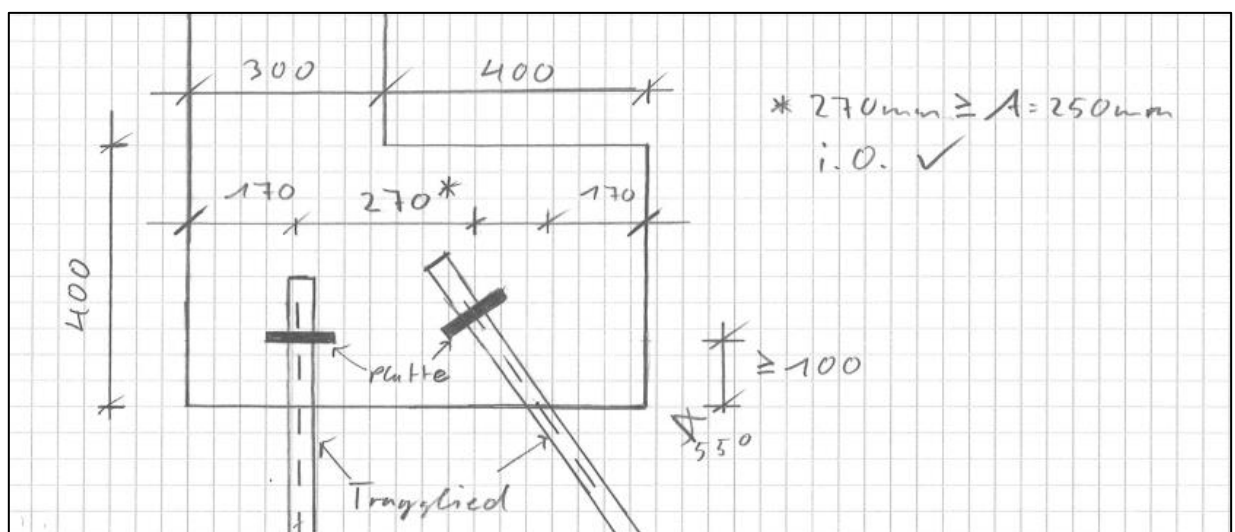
Detailanschluss Kopfbalken mit Mikropfählen
